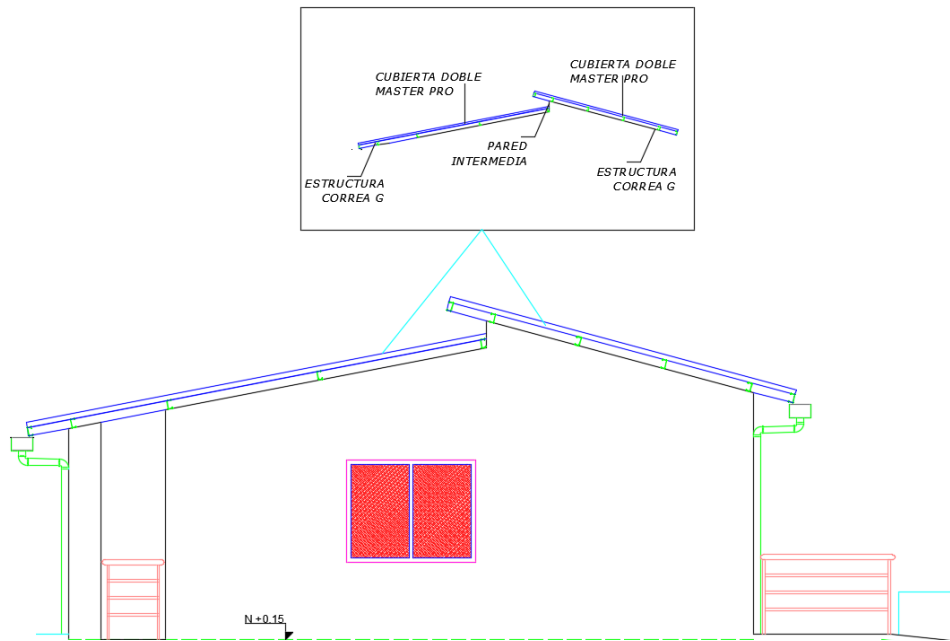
Detalle de la instalación y ubicación de elementos en cubierta.
